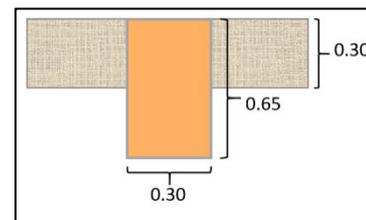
Sección de vigas. Fuente: Elaboración Propia
